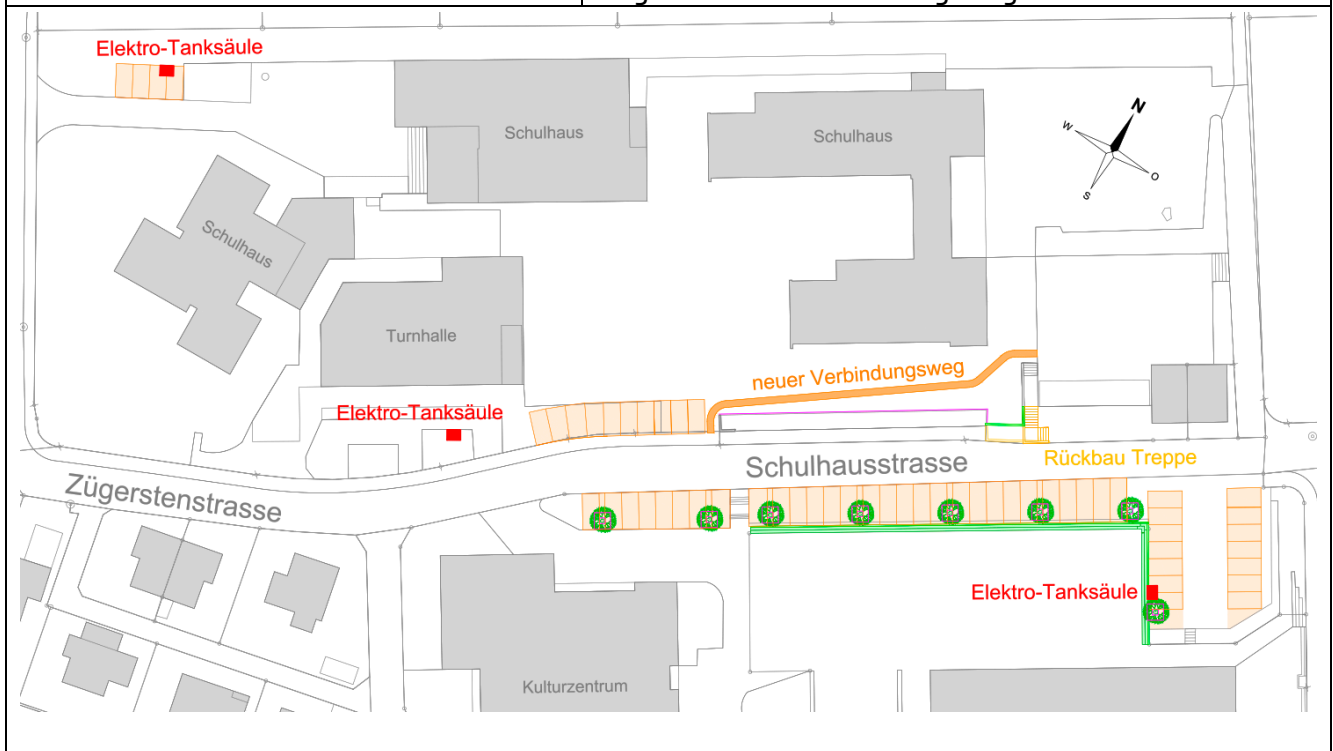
Plan Gestaltung Bereich Schulhausstrasse
